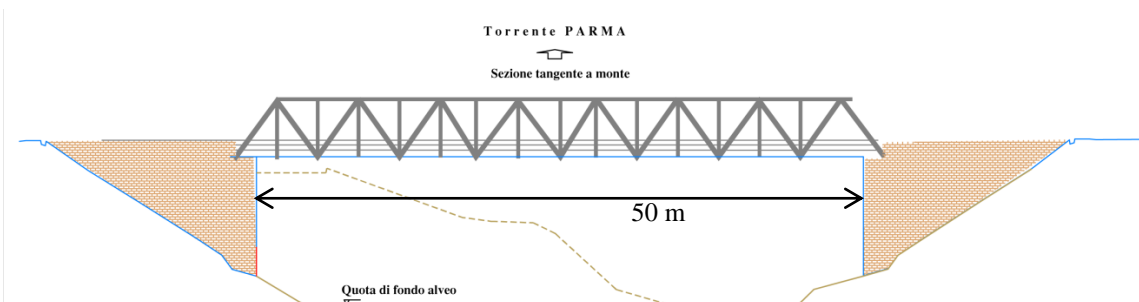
Intervento sul ponte della ferrovia Parma – Brescia.
